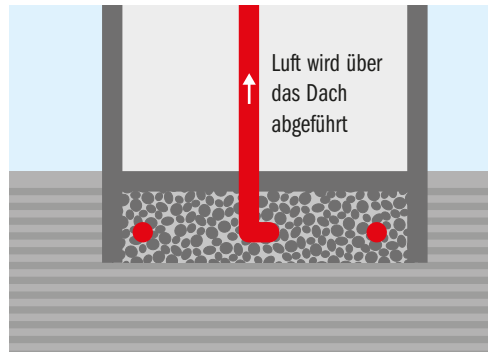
Einbau Radondrainage in Schotter- oder Kiesbett (Rohrabstand bis zu 8 m).
